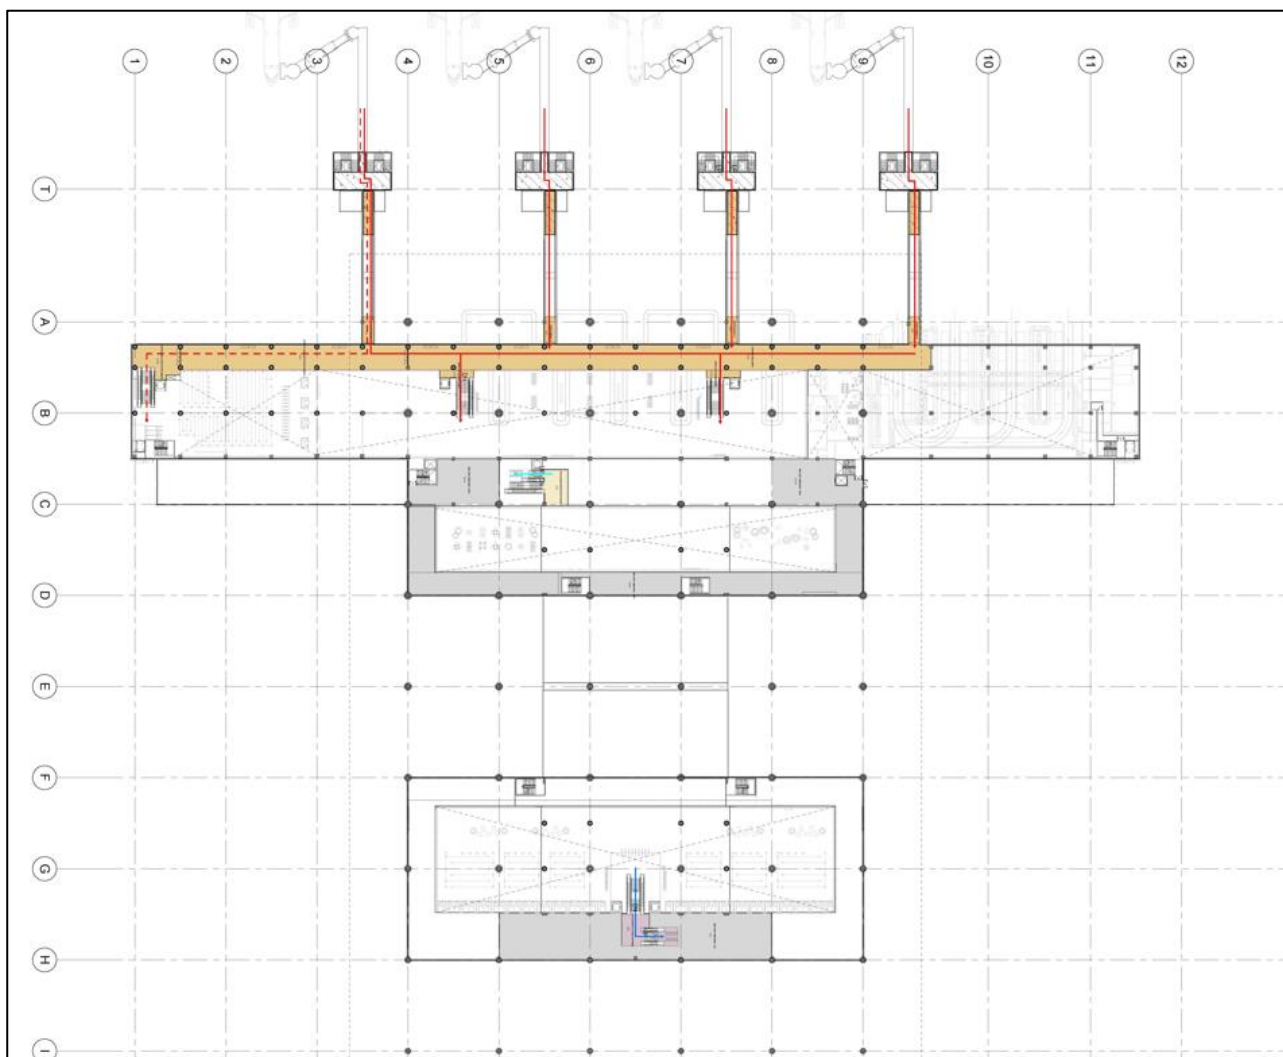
| Planimetria di flussi passeggeri del Piano Mezzanino 2026.
